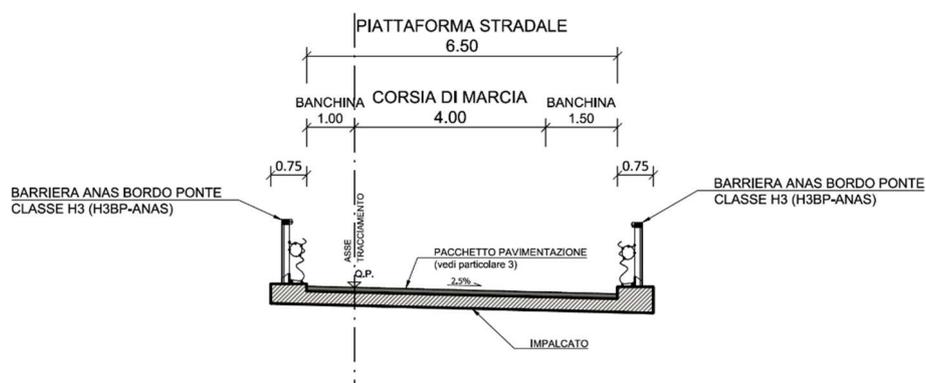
Sezione tipo di rampa monodirezionale in viadotto in rettilo
